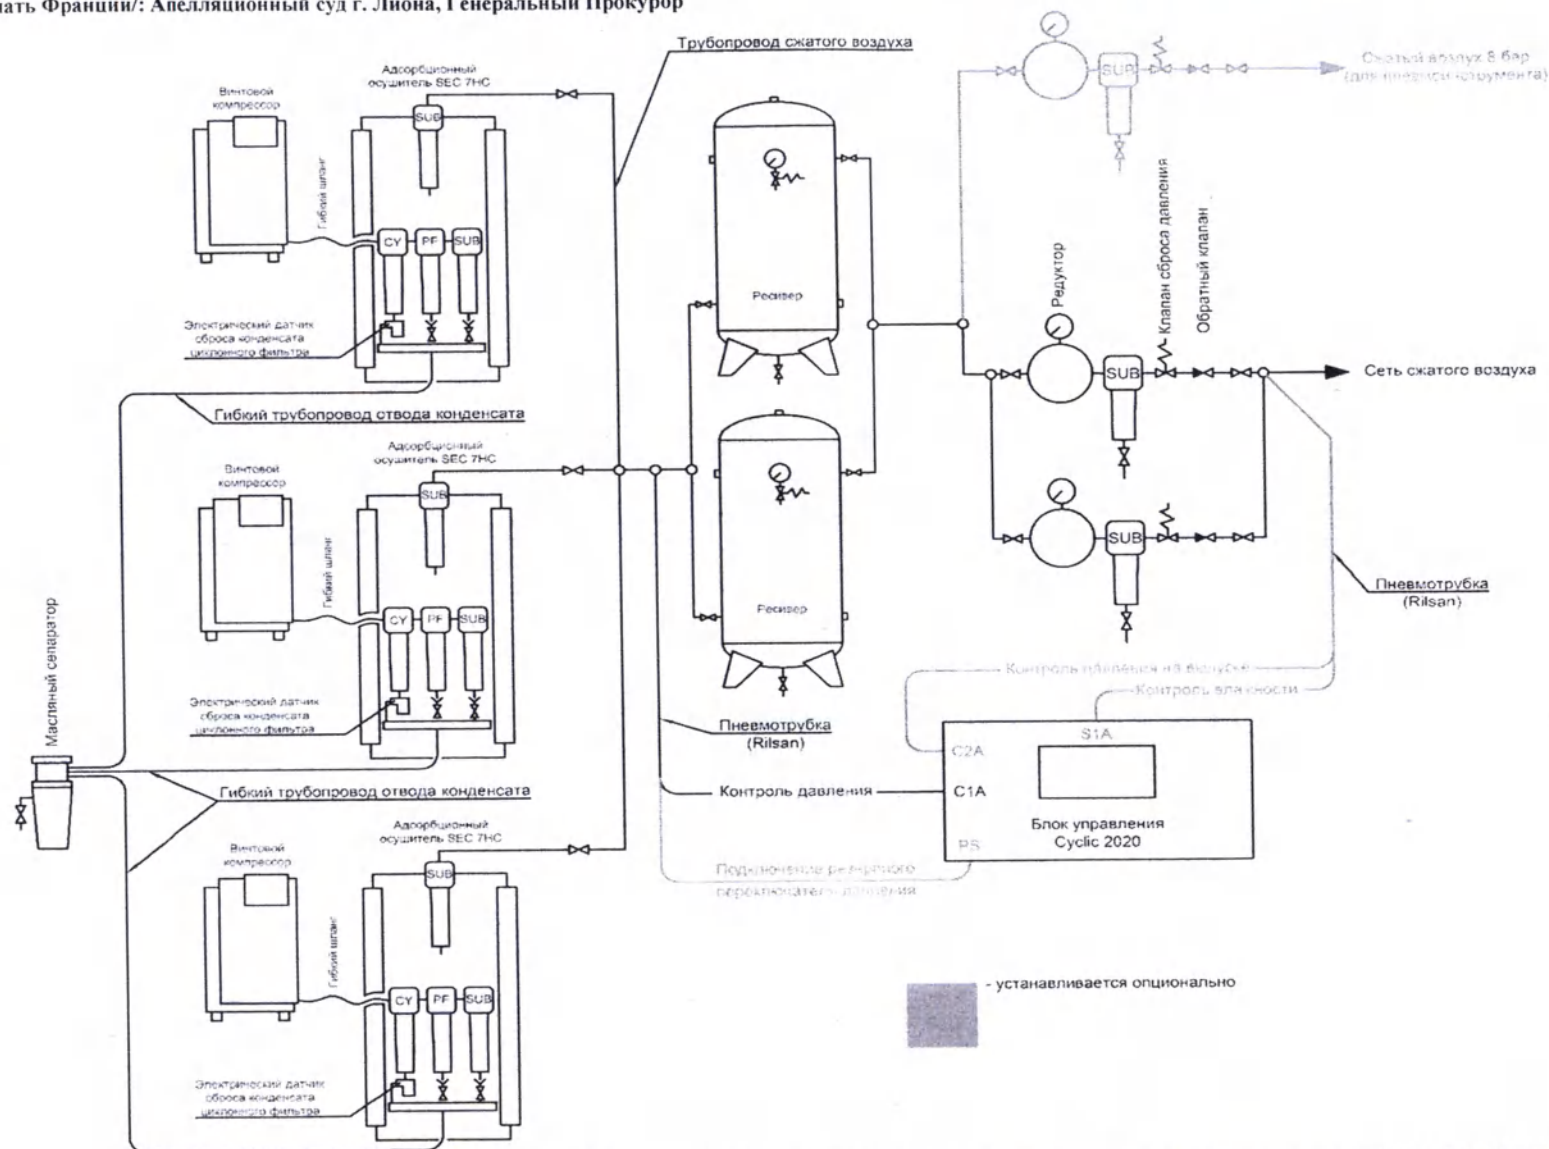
Пневматическая схема, на примере комплектации с тремя компрессорами и двумя ресиверами (допускается как параллельное, так и последовательное расположение ресиверов)
